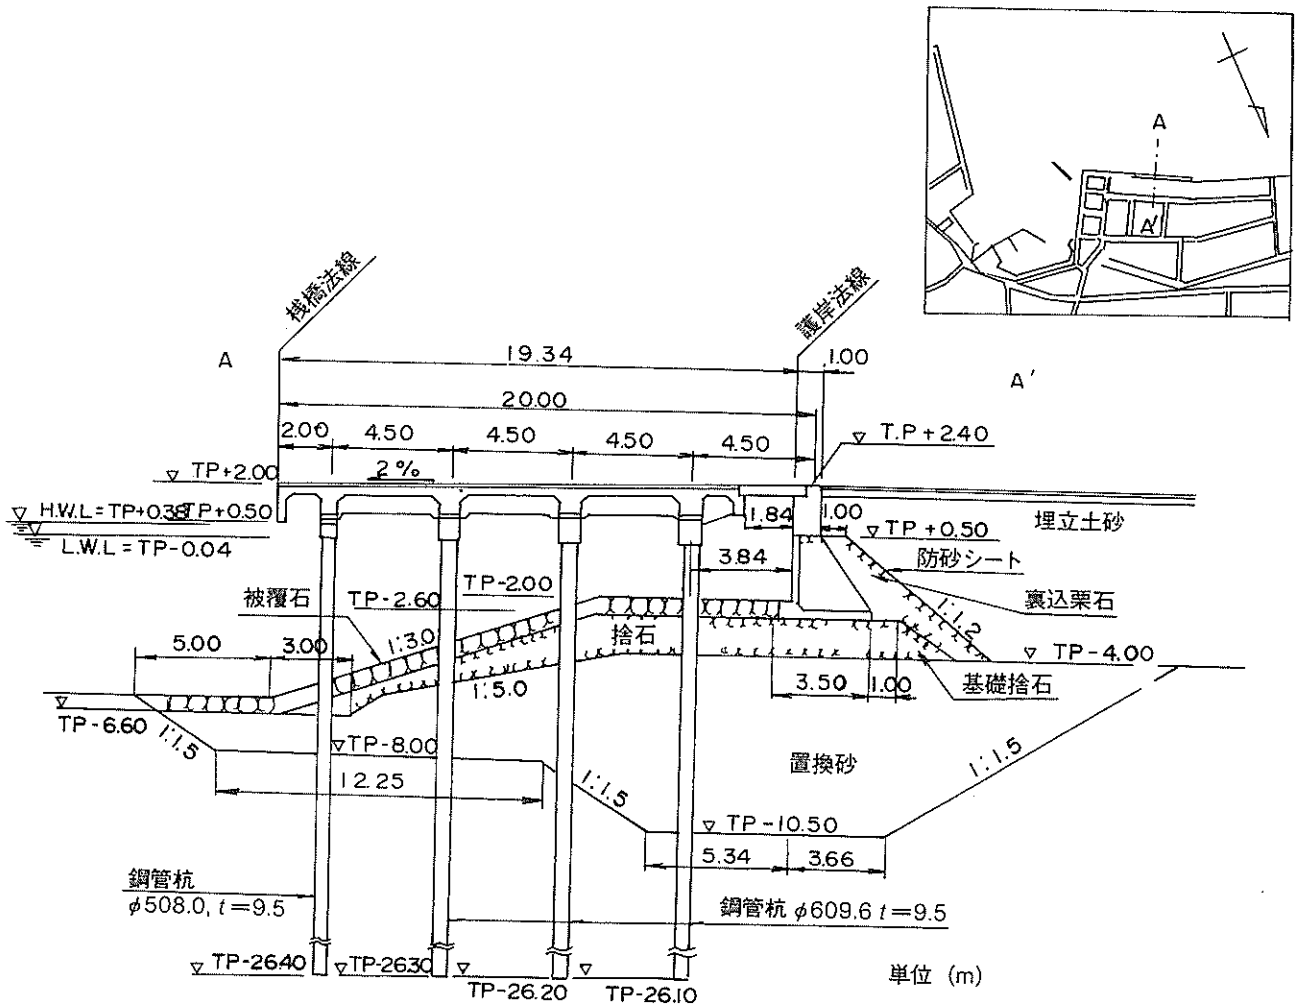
岸壁(-6.0m) (施設番号②)の標準断面
